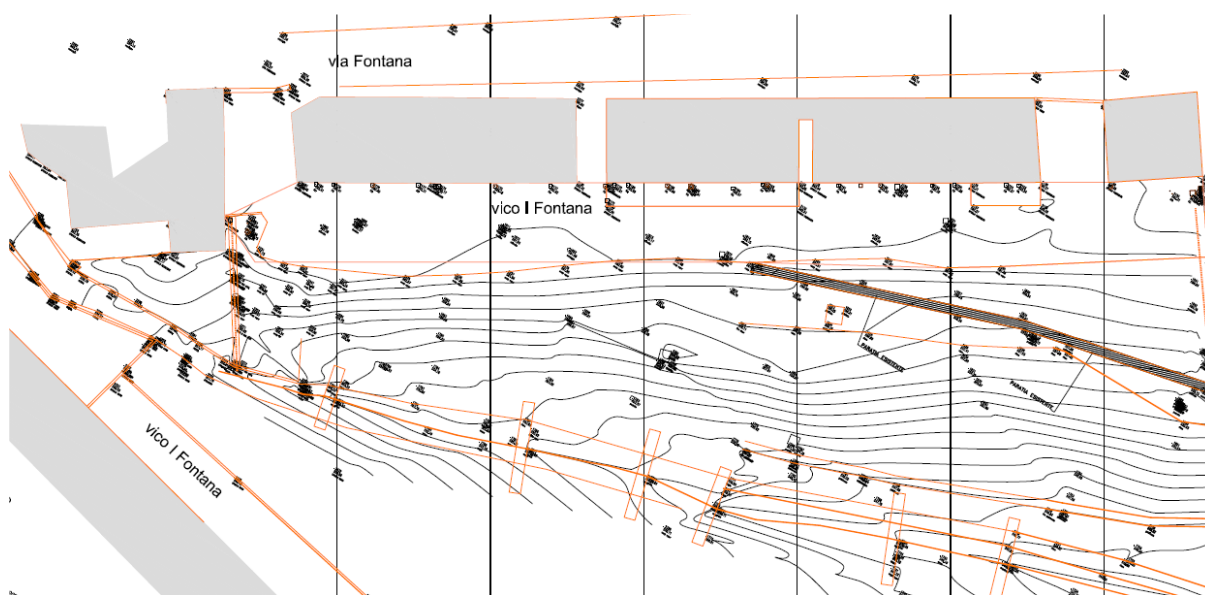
Vico I Fontana - Planimetria ante-operam
